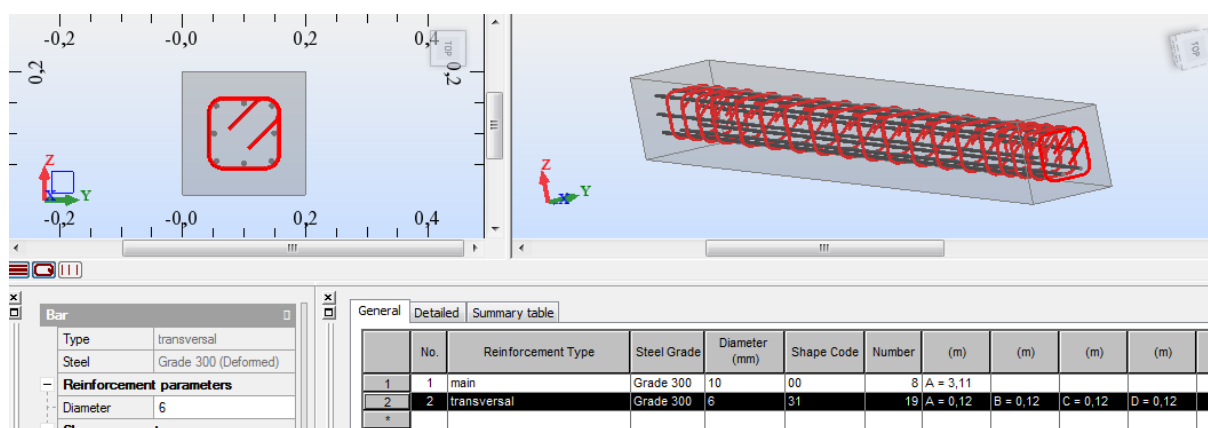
Armadura transversal - Pilar de extremidade P2
